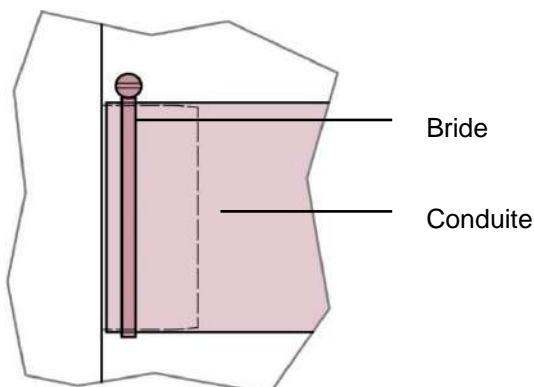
Raccorder la conduite à la tubulure d'entrée d'air
